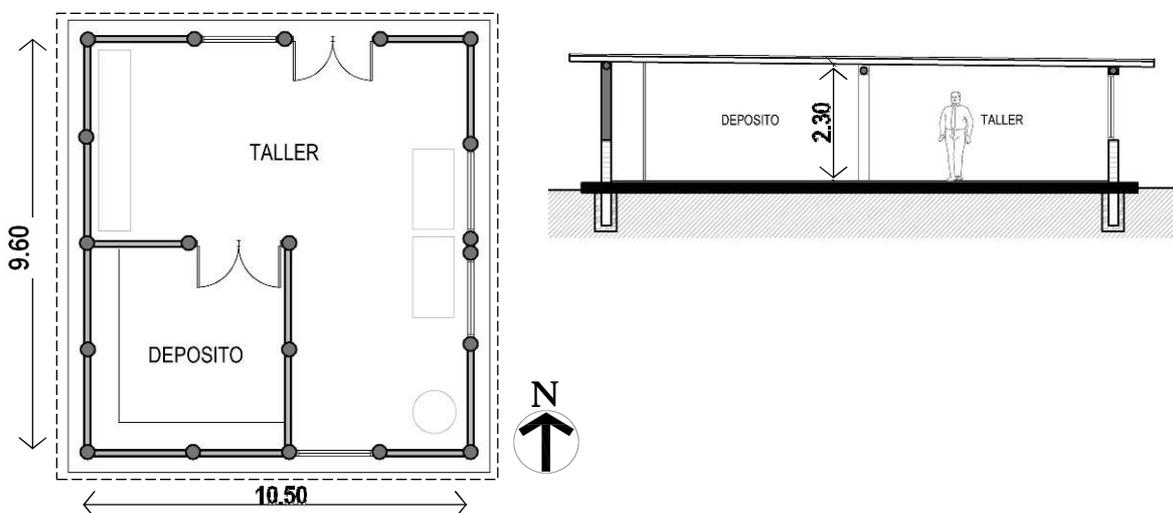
Planta y corte del proyecto. (FUENTE: Arq. Esteban Fernández, 1999)
